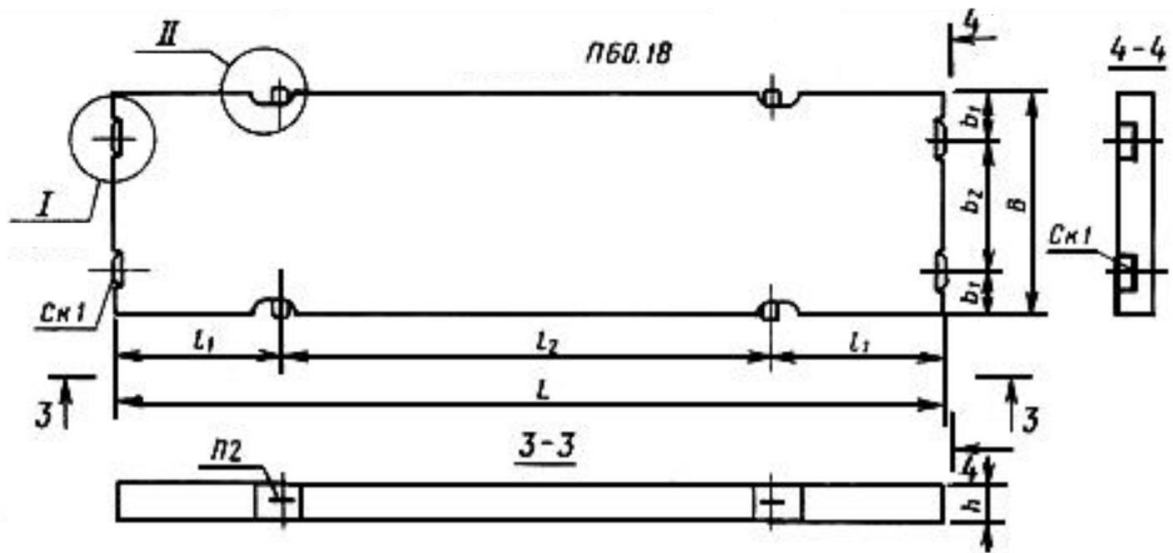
Общий вид предварительно напряженной железобетонной дорожной плиты 1П60.18-30AIV
